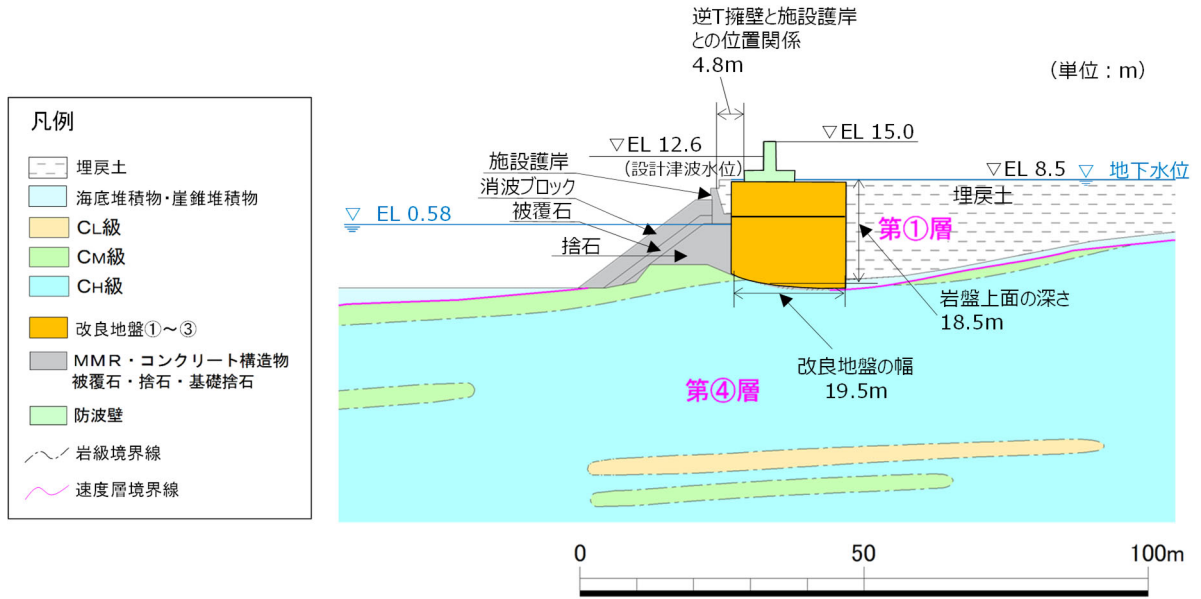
防波壁（逆 T 擁壁）の横断面図（⑤-⑤断面）
